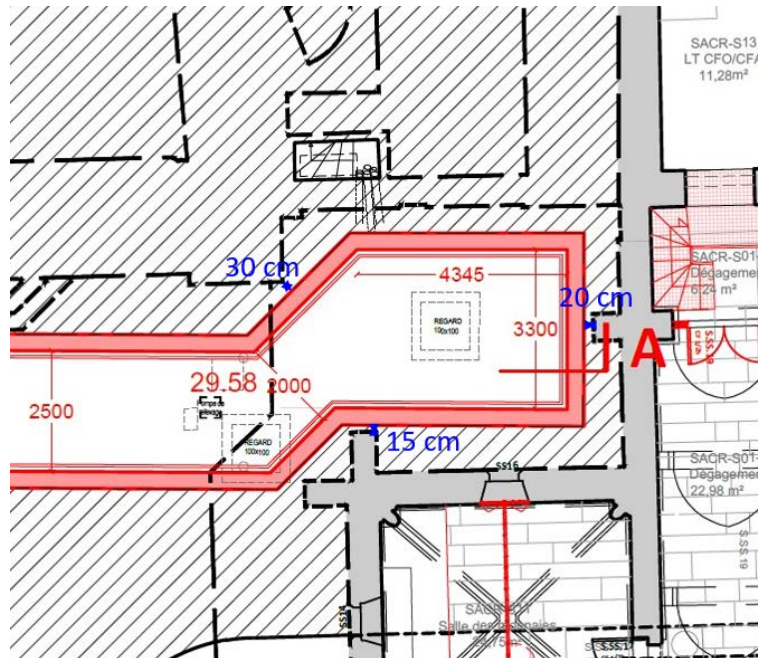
Extrait du plan [3] avec report de la distance entre la galerie et les façades
